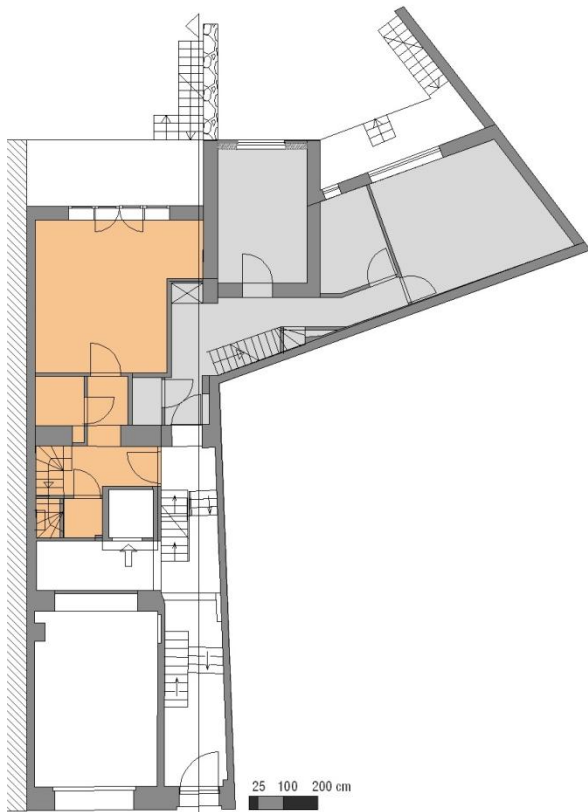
Plan du rez-de-chaussée (Source : Draps E., 2010)
